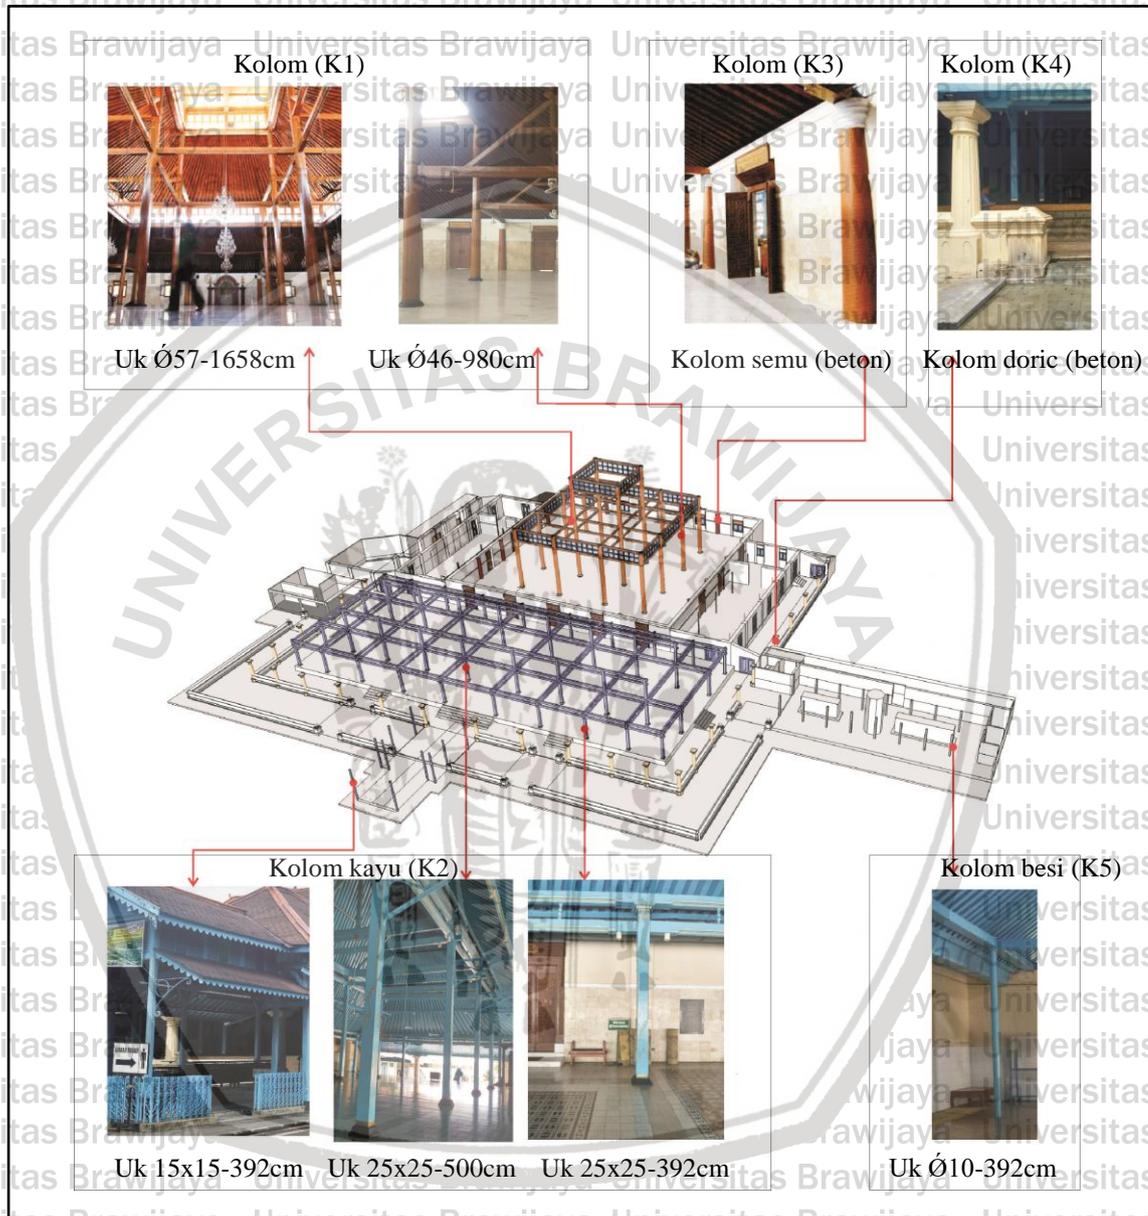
Denah kolom Masjid Agung Surakarta
